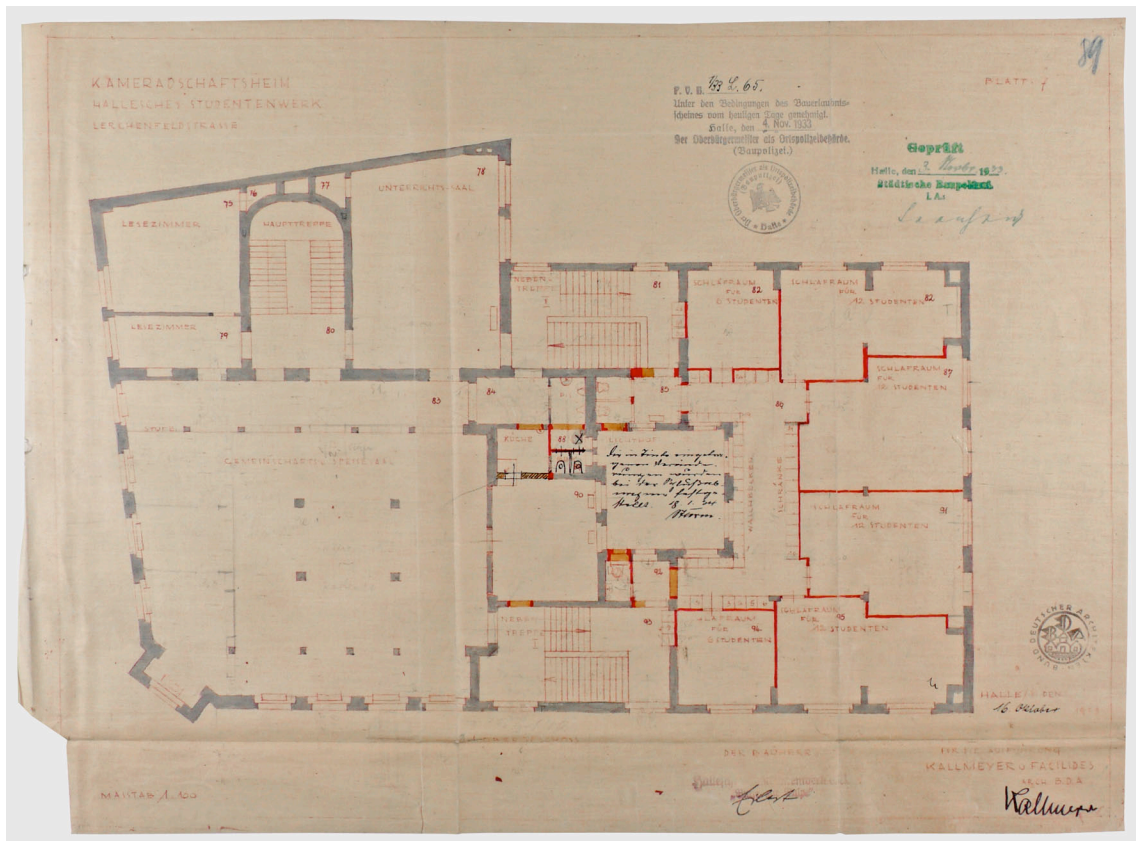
Gebäude in der Lerchenfeldstraße 14 in Halle, Grundriss erstes Obergeschoss, datiert 16. Oktober 1933.
